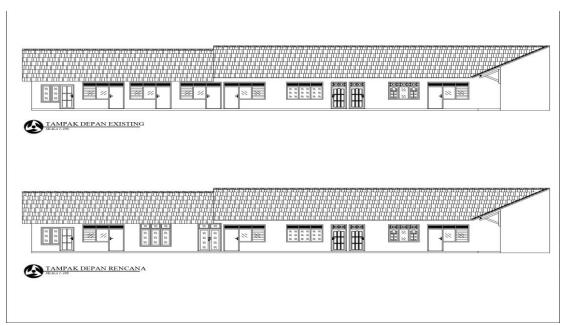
Existing Zona 1 dan Rencana Zona 1
